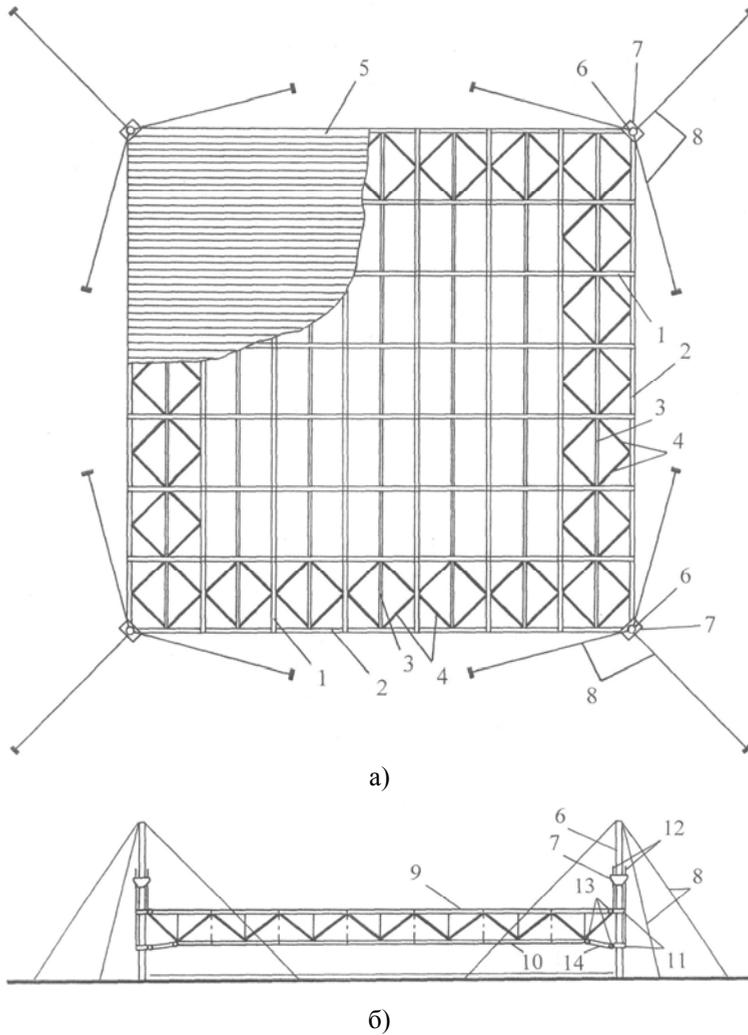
Схемы пространственного покрытия из перекрестной системы в процессе монтажа по методу подъема: а – вид сверху; б – вид сбоку в начальной стадии подъема; 1 – внутренние фермы; 2 – контурные фермы; 3 – прогоны; 4 – приконтурные связи по нижним поясам ферм; 5 – профилированный настил; 6 – угловые колонны; 7 – подъемники; 8 – расчалки; 9 – верхний пояс контурных ферм; 10 – нижний пояс контурных ферм; 11 – парные обоймы; 12 – грузовые тяги; 13 – шарниры; 14 – стержневые элементы с парными реверсивными устройствами
